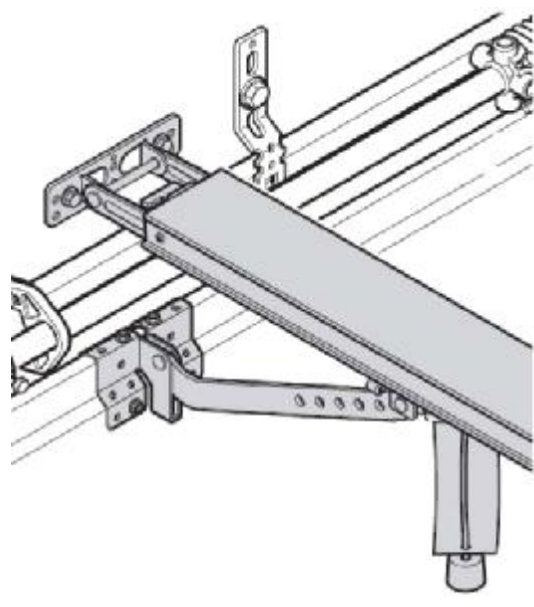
Widok bramy segmentowej garażowej podnoszonej z napędem mechanicznym
